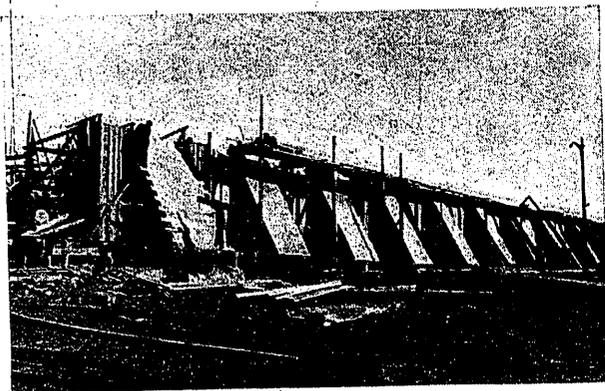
Canal. Construcción de la zona de contrafuertes.
